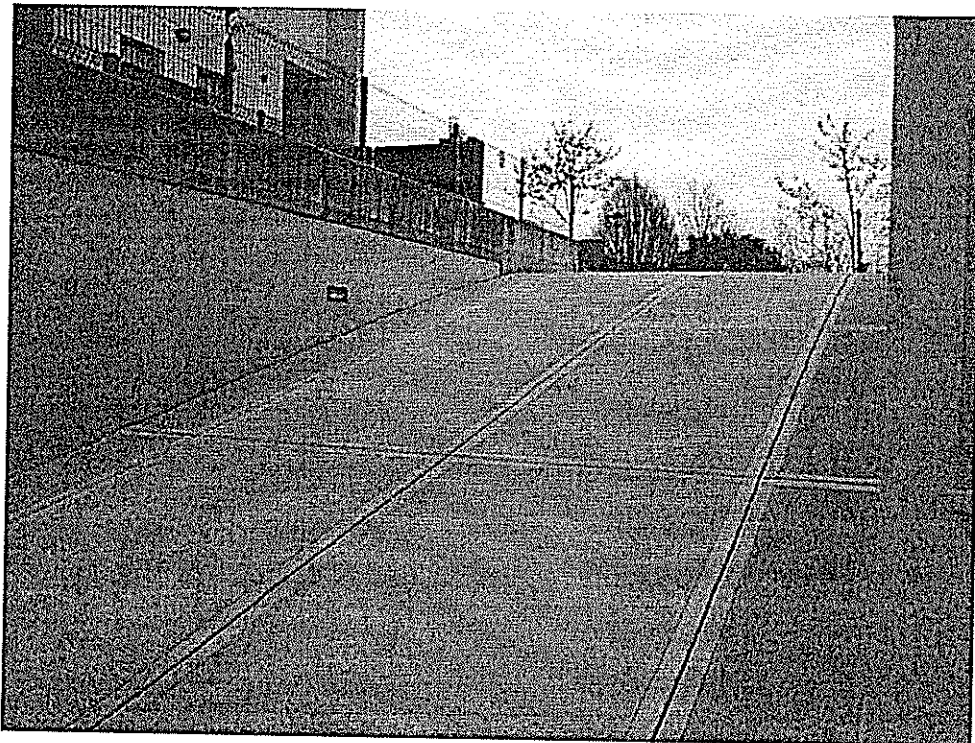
LOTTO B2: visione rampa di accesso al piano interrato
